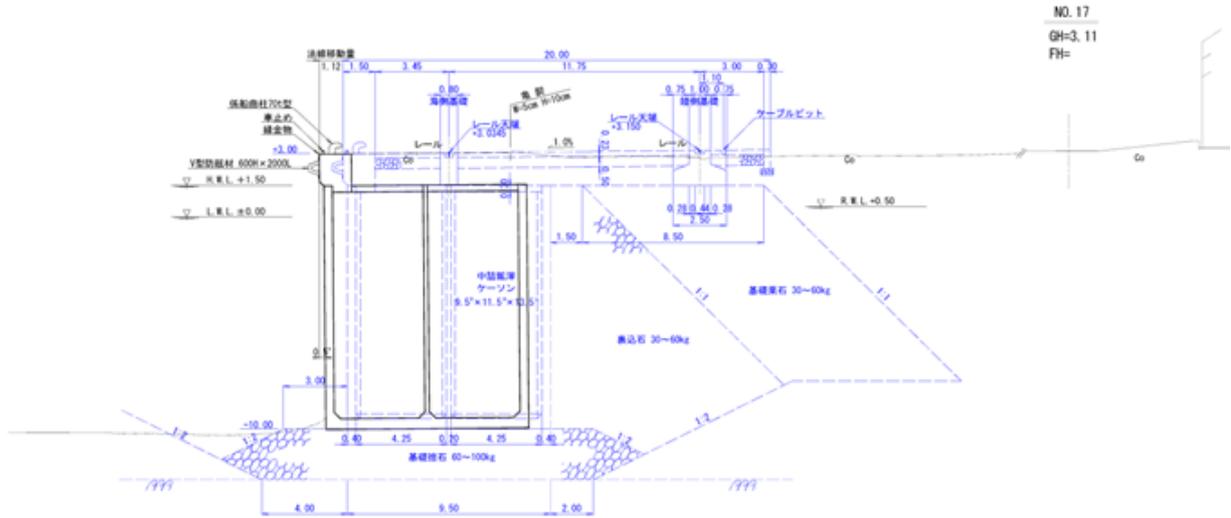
No.4 日立港区_第1ふ頭地区 1-D 岸壁 (-10.0m) の断面図 (被災前・後)
